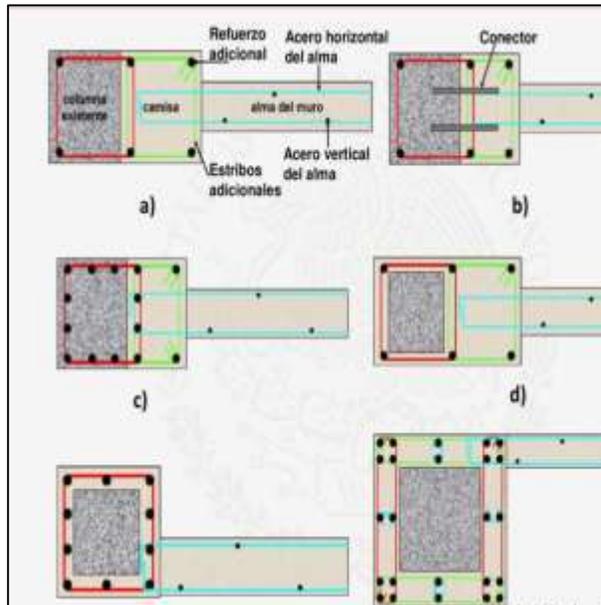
Envoltente de concreto y muro lateral en columna existente.
